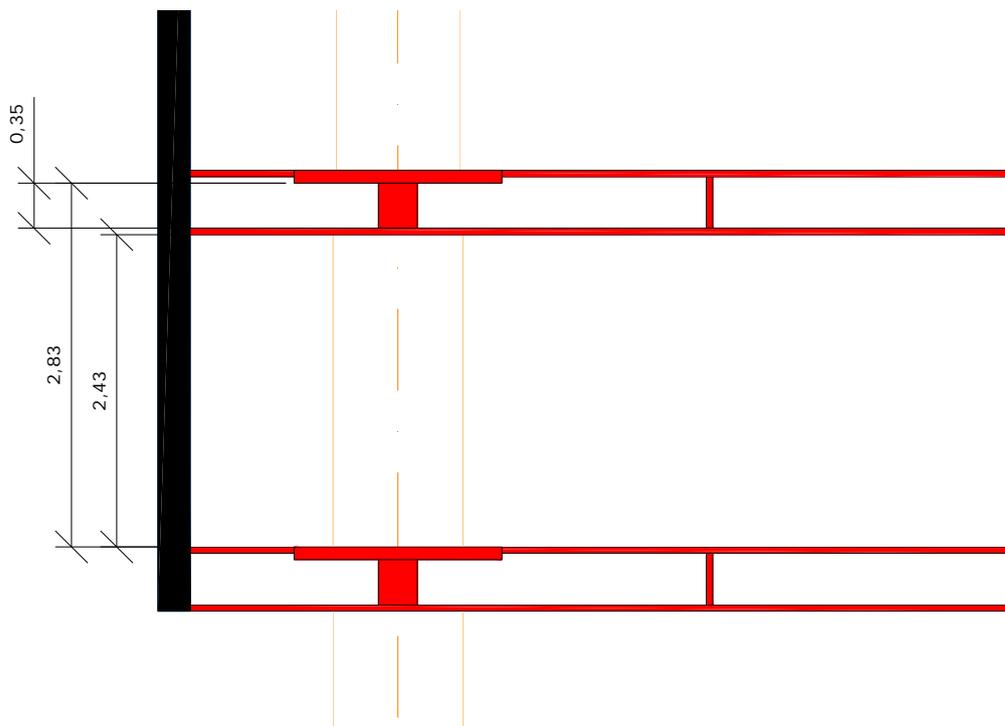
Corte esquemático do primeiro e segundo andares.
